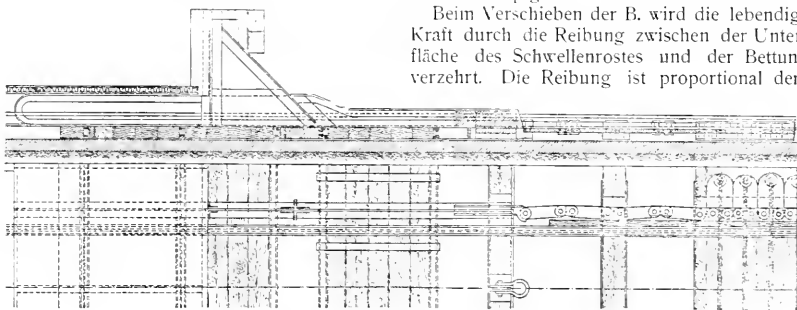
Bufferwehr, von Rawie, mit einrückenden Schwellen.
